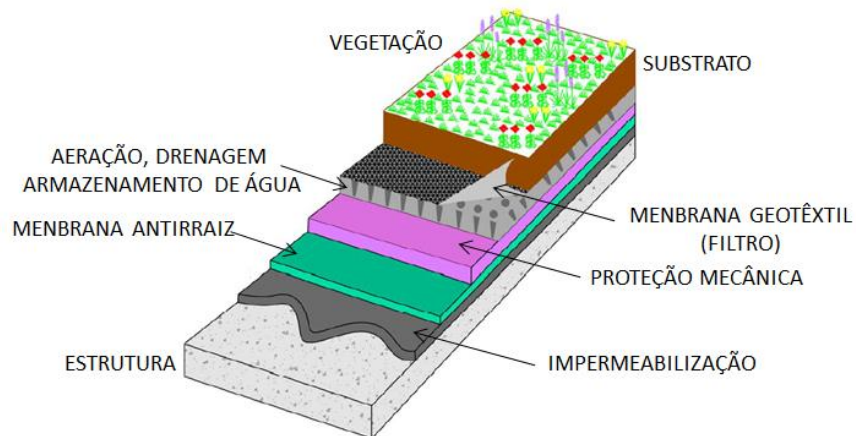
Corte típico do sistema de multicamadas de um telhado verde
